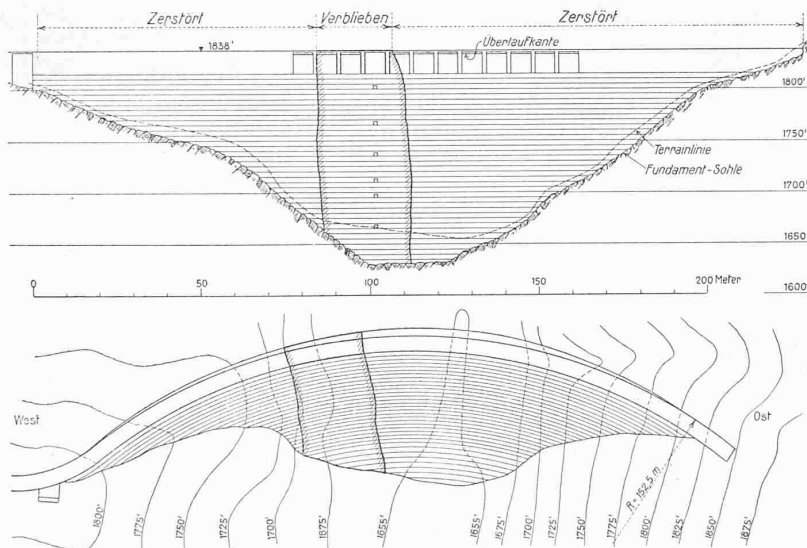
Grundriss und Ansicht der Mauer. — Masstab 1 : 2000.
